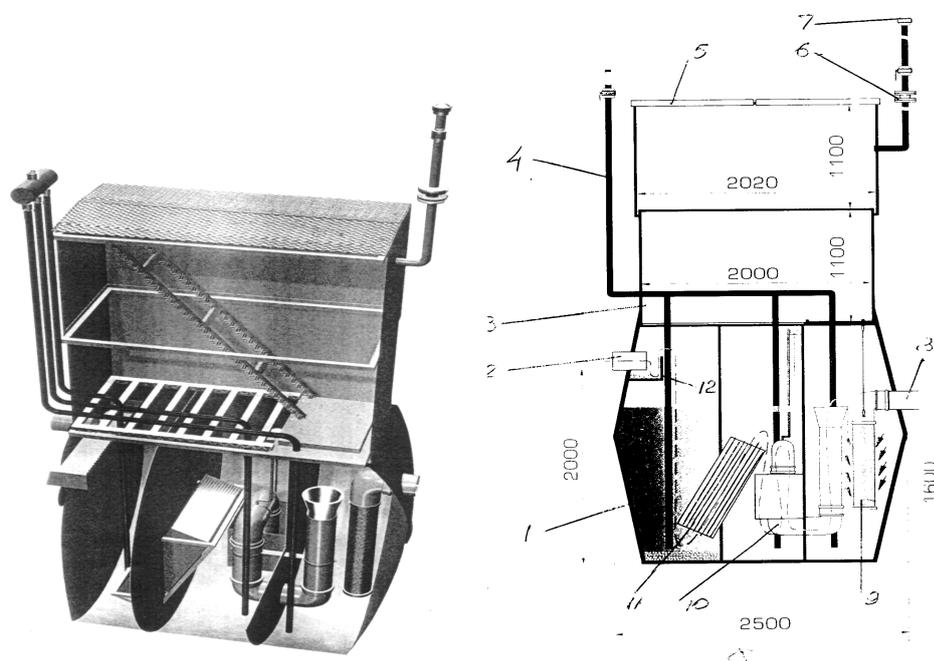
Нефтегрязеуловитель для очистки поверхностных вод производительностью 3 л/с : а- общий вид ; б- схема : 1- трех секционный корпус ; 2- входной патрубок ; 3- прямоугольный телескопический колодец ; 4- система удаления осадка ; 5- крышка колодца ; 6- огневой предохранитель ; 7- дыхательный клапан ; 8- выходной патрубок ; 9- сорбционный угольный фильтр ; 10- нефтеулавливающий сифон ; 11- тонкослойный динамический отстойник ; 12- пескоулавливающий лоток
